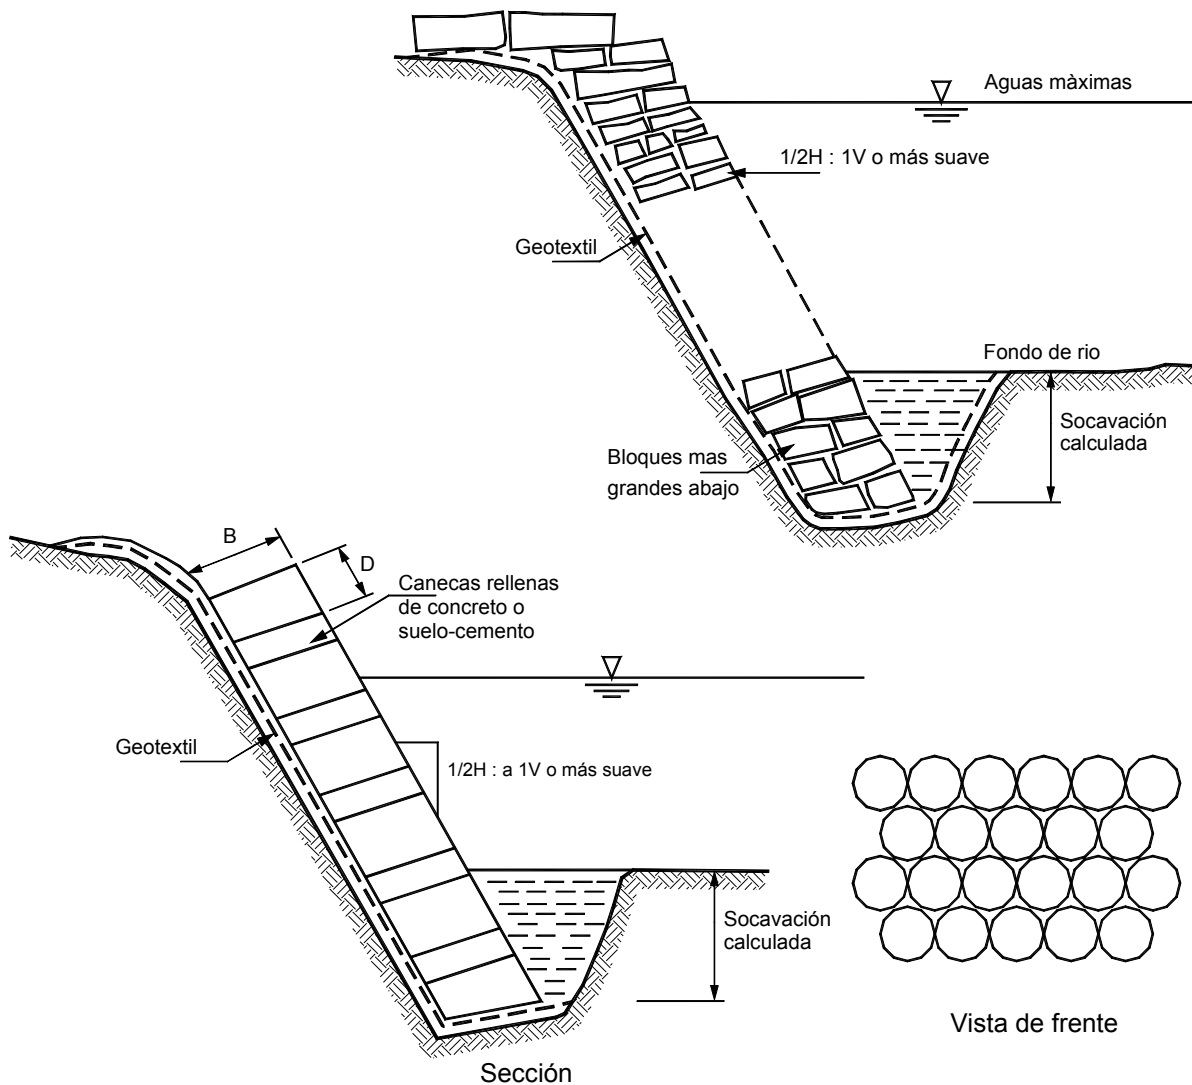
Protección de un talud con canecas llenas de concreto.
